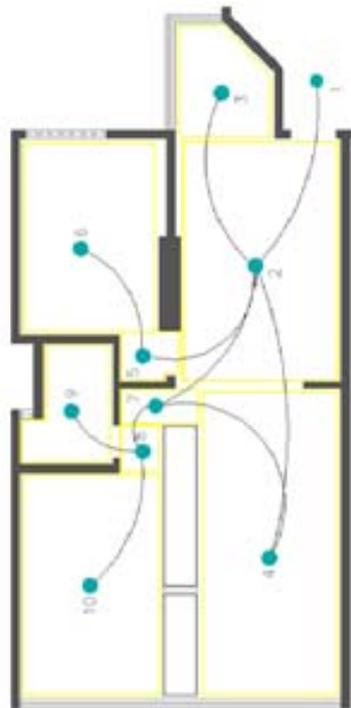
QRSW 2 – Bloco B5 – Sudoeste Econômico – Planta Modificada
